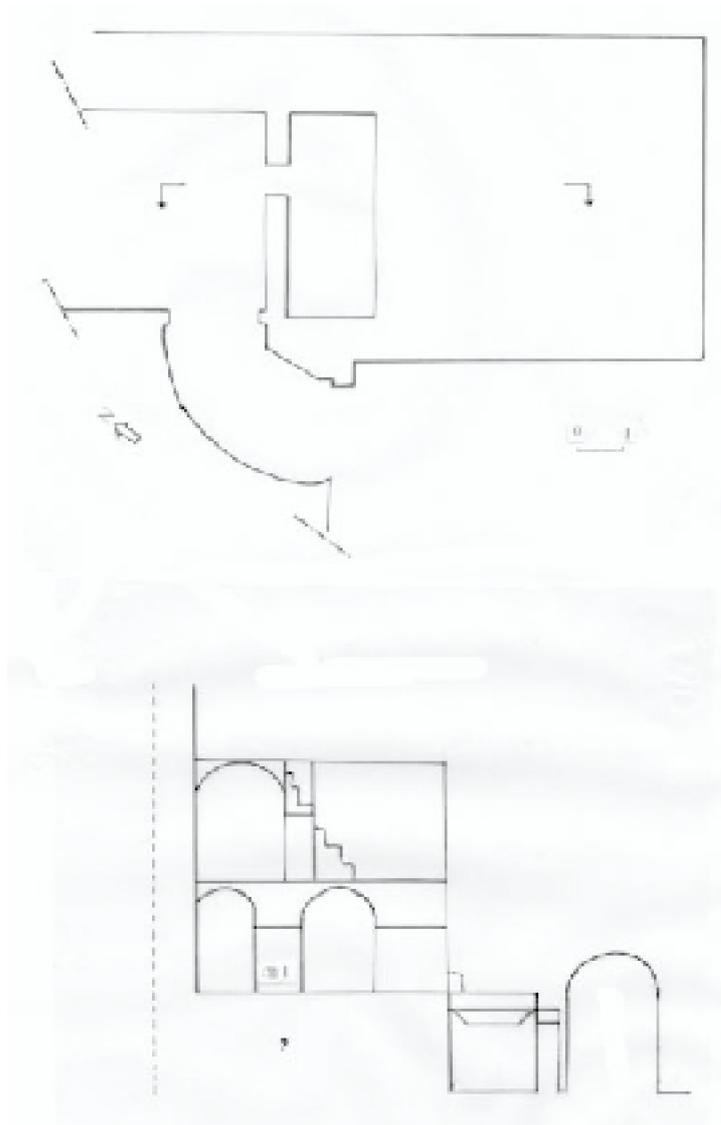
Le site d'Ayyūn. Plan et coupe de la porte sud et de la tour qui lui est adjacente.
